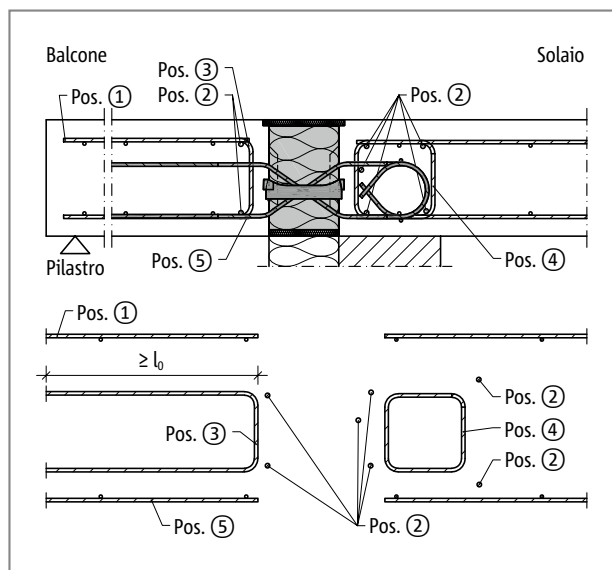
Schöck Isokorb® XT tipo QL-VV1 a VV4: armatura in opera
